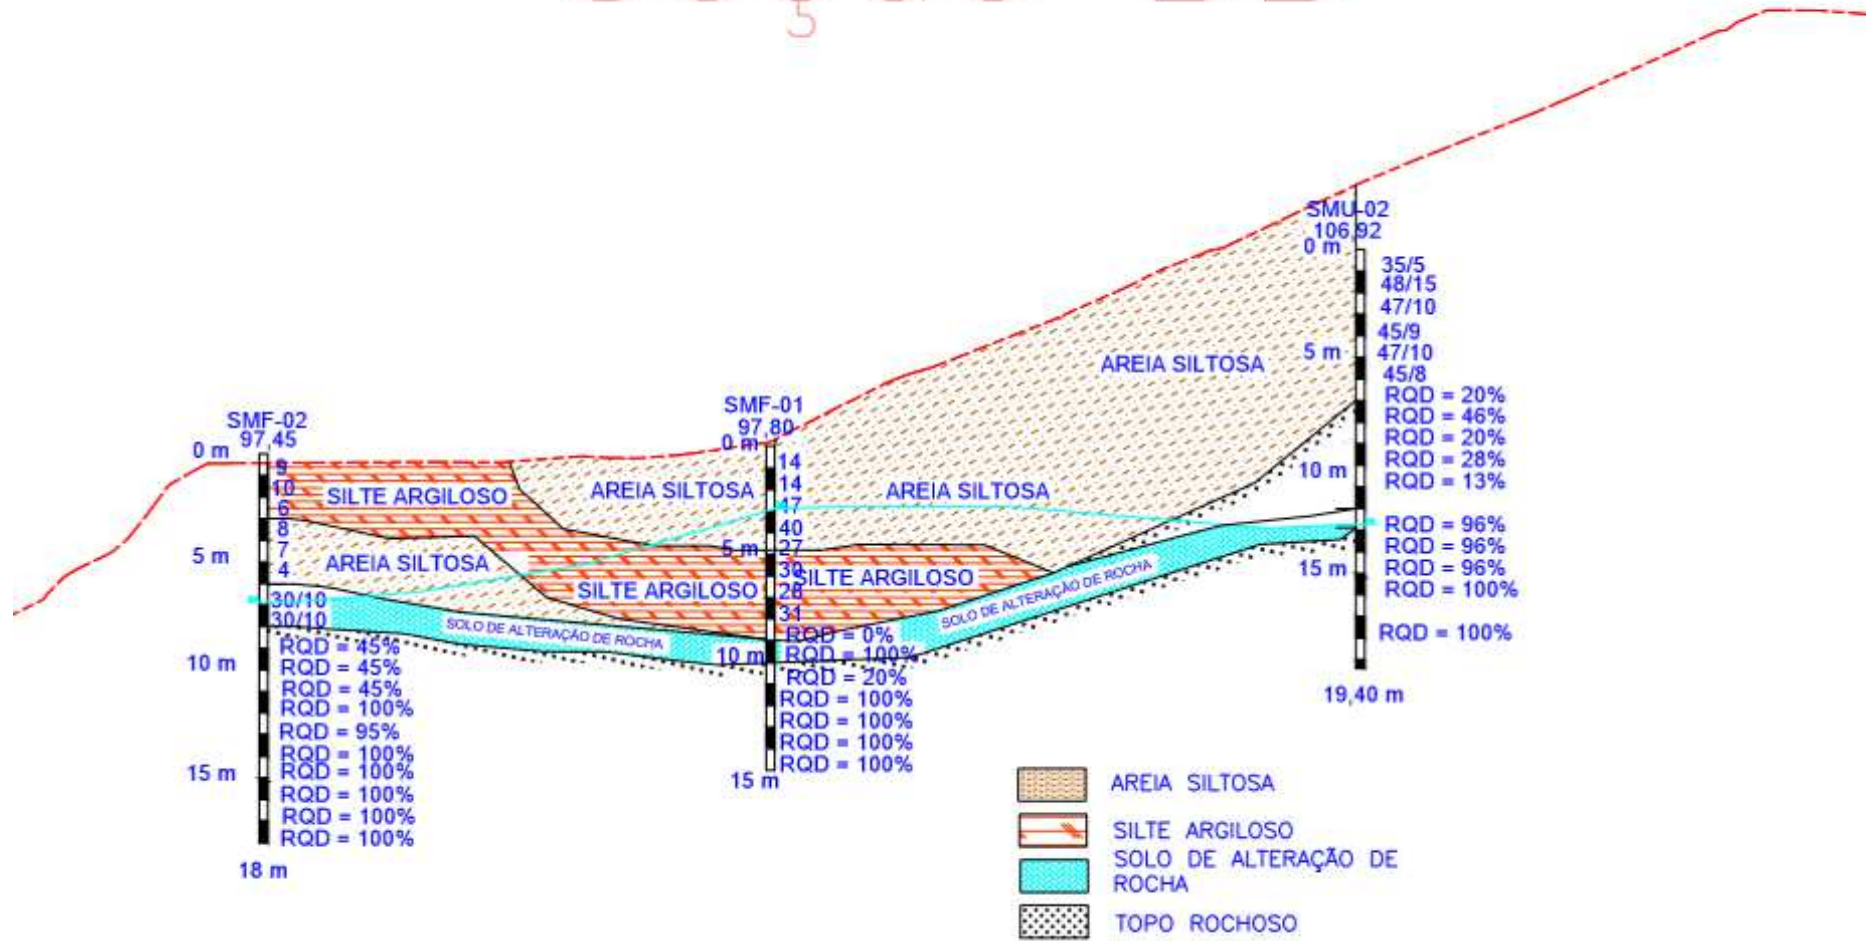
Perfil Geotécnico definido pelas Sondagens Mistas – Seção “BB”.
